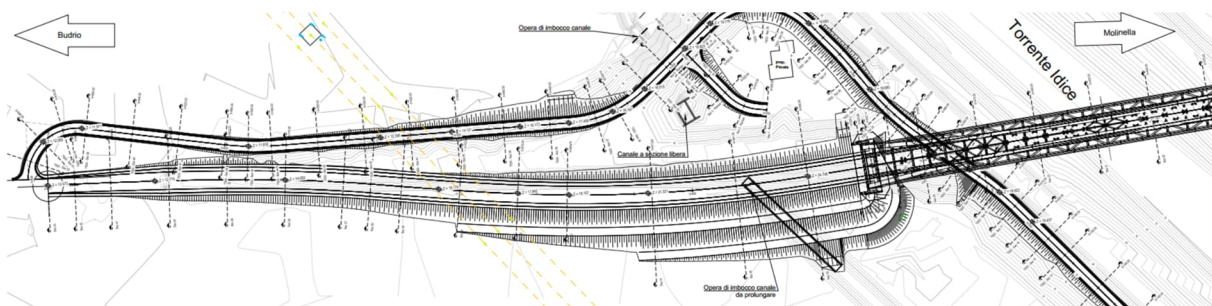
Planimetria del tracciato principale lato sponda destra idraulica
